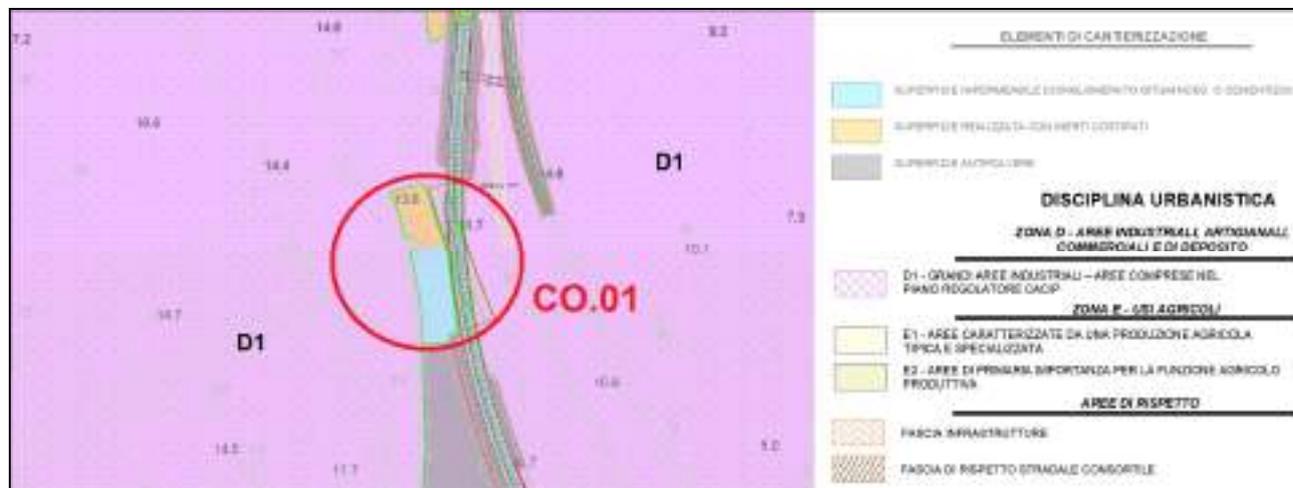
Sovrapposizione del tracciato e delle aree di cantiere operativo-stoccaggio sulla perimetrazione urbanistica – Cantiere Operativo CO.01.
